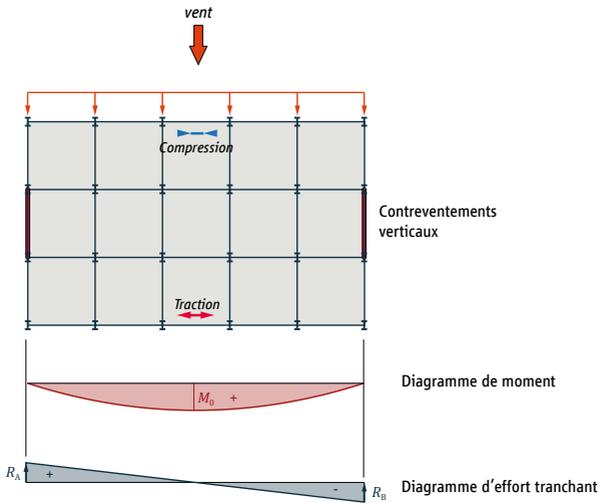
Sollicitations dans une dalle fonctionnant en diaphragme horizontal
